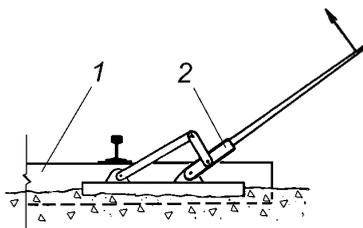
Рычажный рихтовочный прибор: 1 – шпала; 2 – прибор
